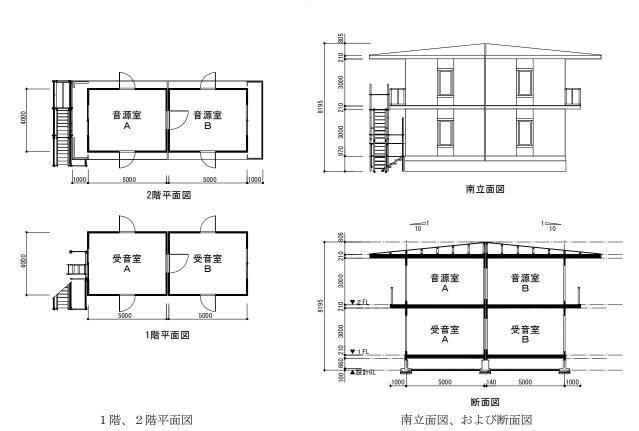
CLT遮音実験棟の立面図・断面図・平面図(寸法単位:mm)
